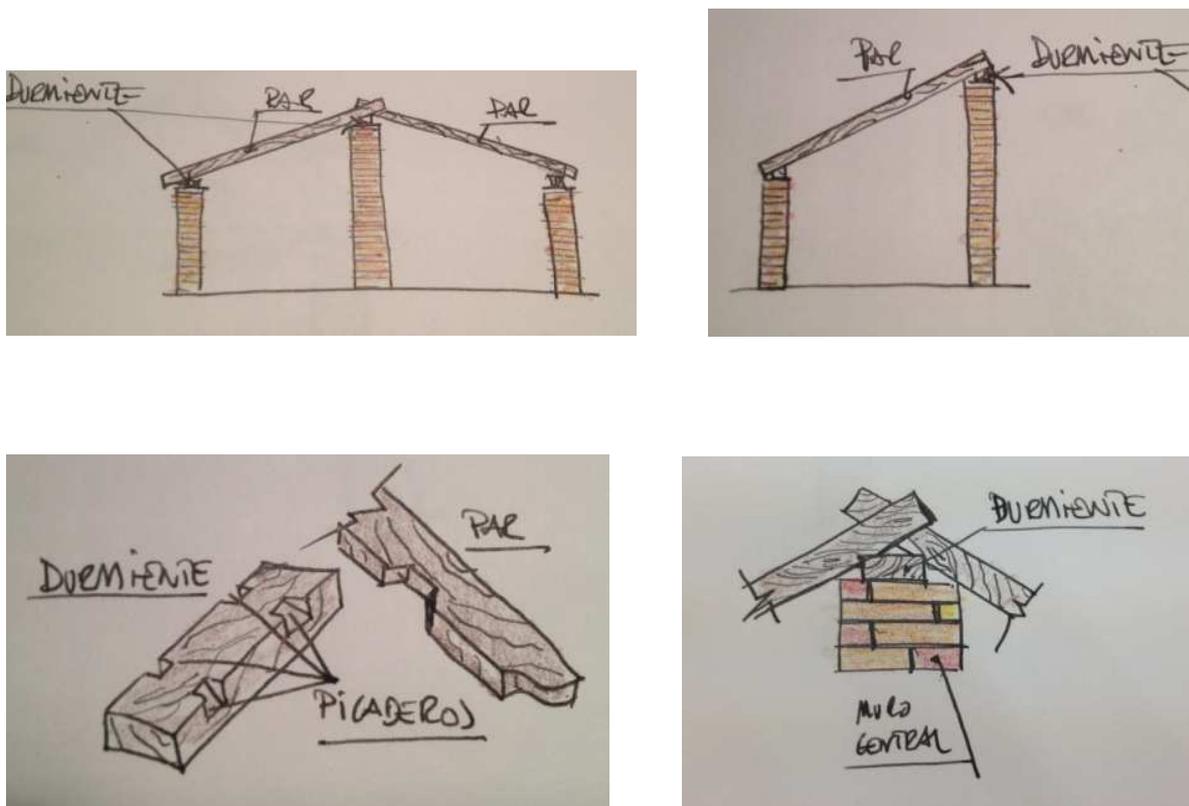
Detalle de cubierta de par y picadero (MARÍN)
